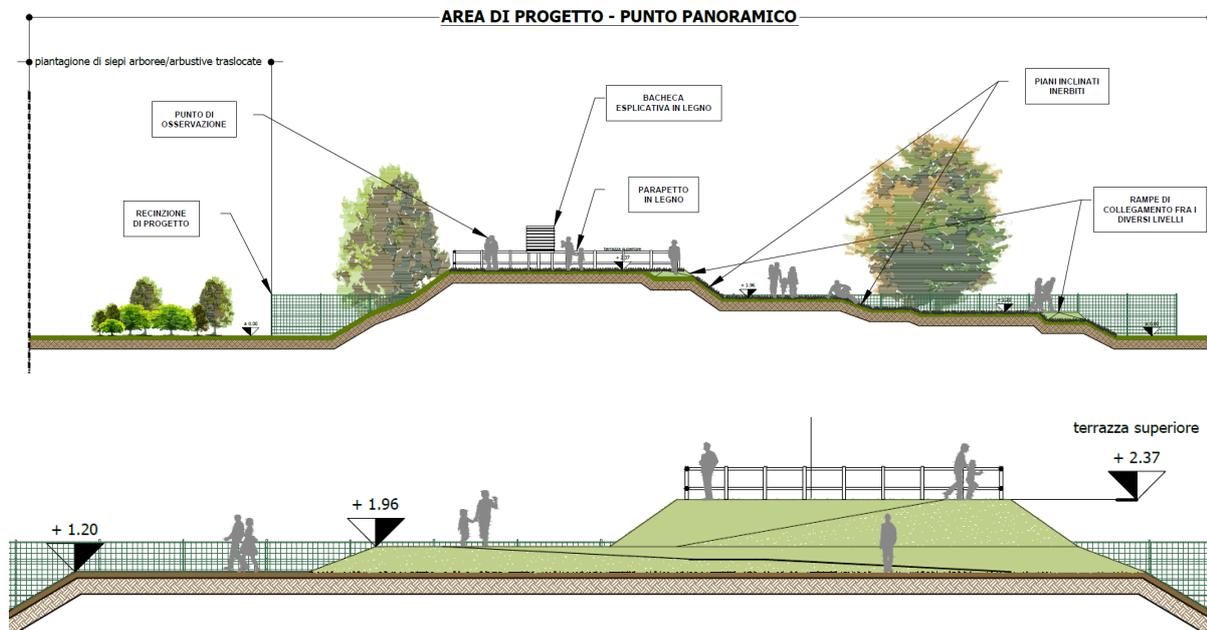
Area Prataccio – Sezioni della collinetta Osservatorio
